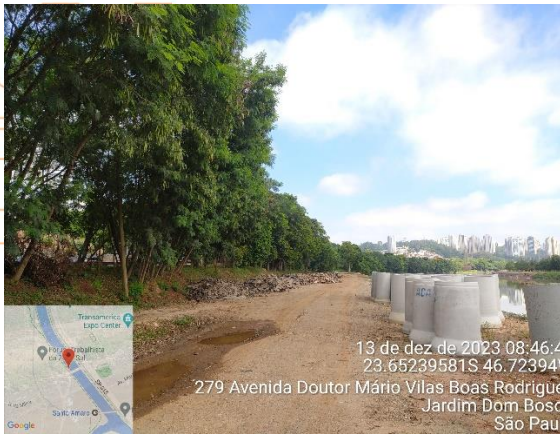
Vista da ADA em trecho do Parque Linear Bruno Covas.
